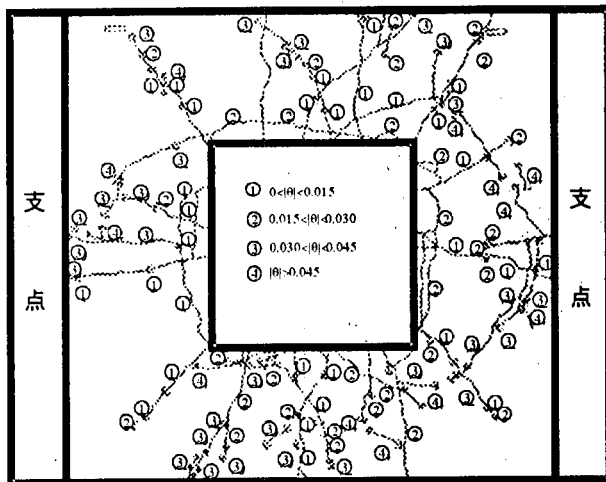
繰り返し載荷時のひび割れ状況
